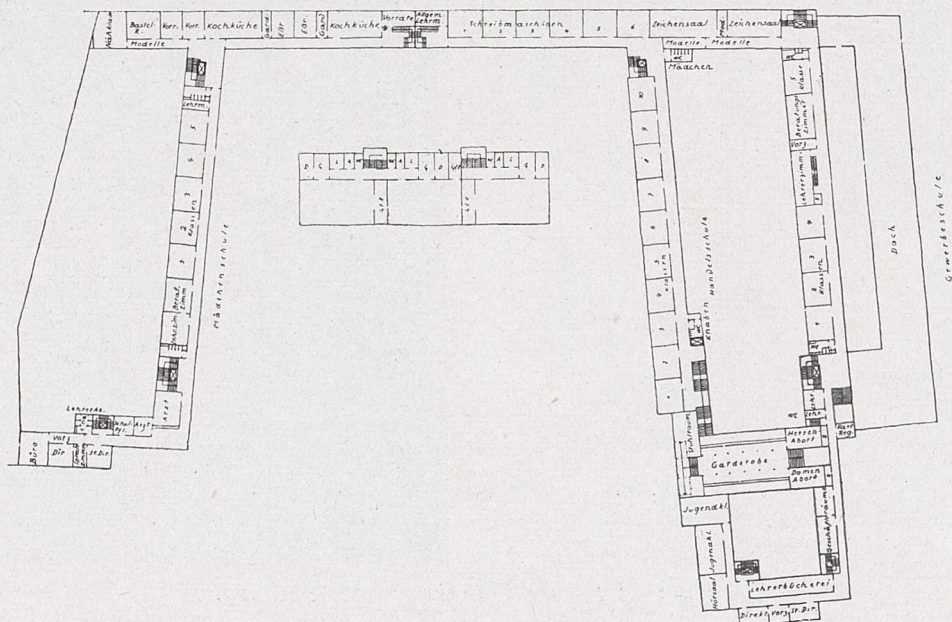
Grundriß vom I. Obergeschoß. M. 1:2000.
